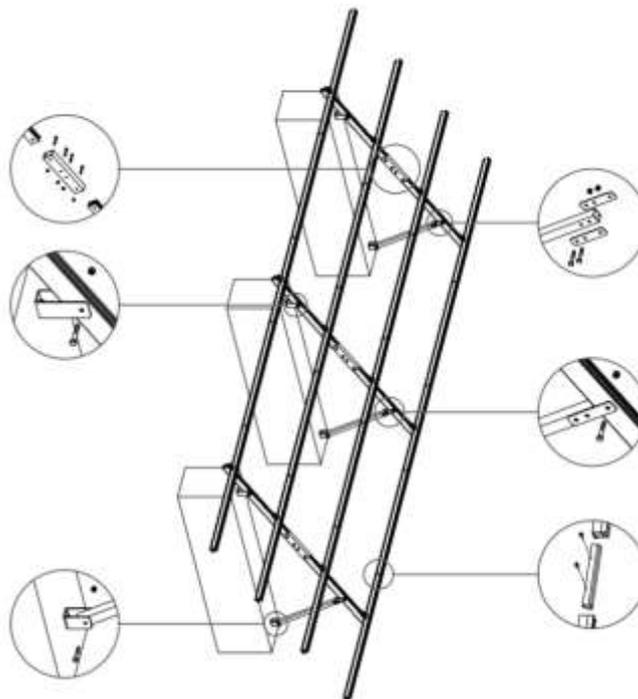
Soporte A-Rack para paneles fotovoltaicos situados en el muro
